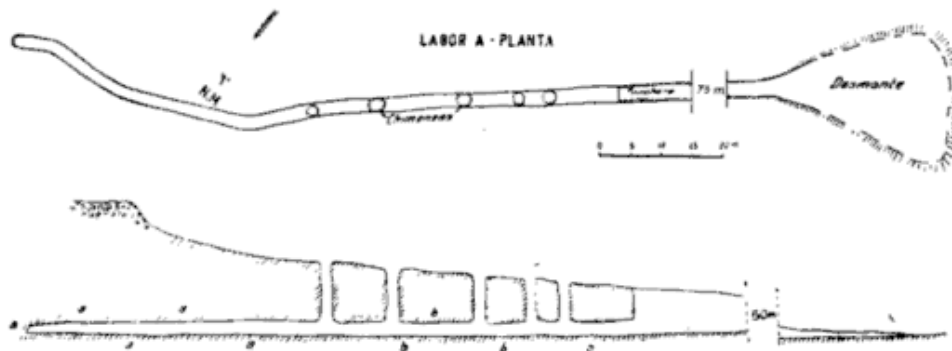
« San Alfredo », Mutquin. Planta y corte longitudinal de la labor A
